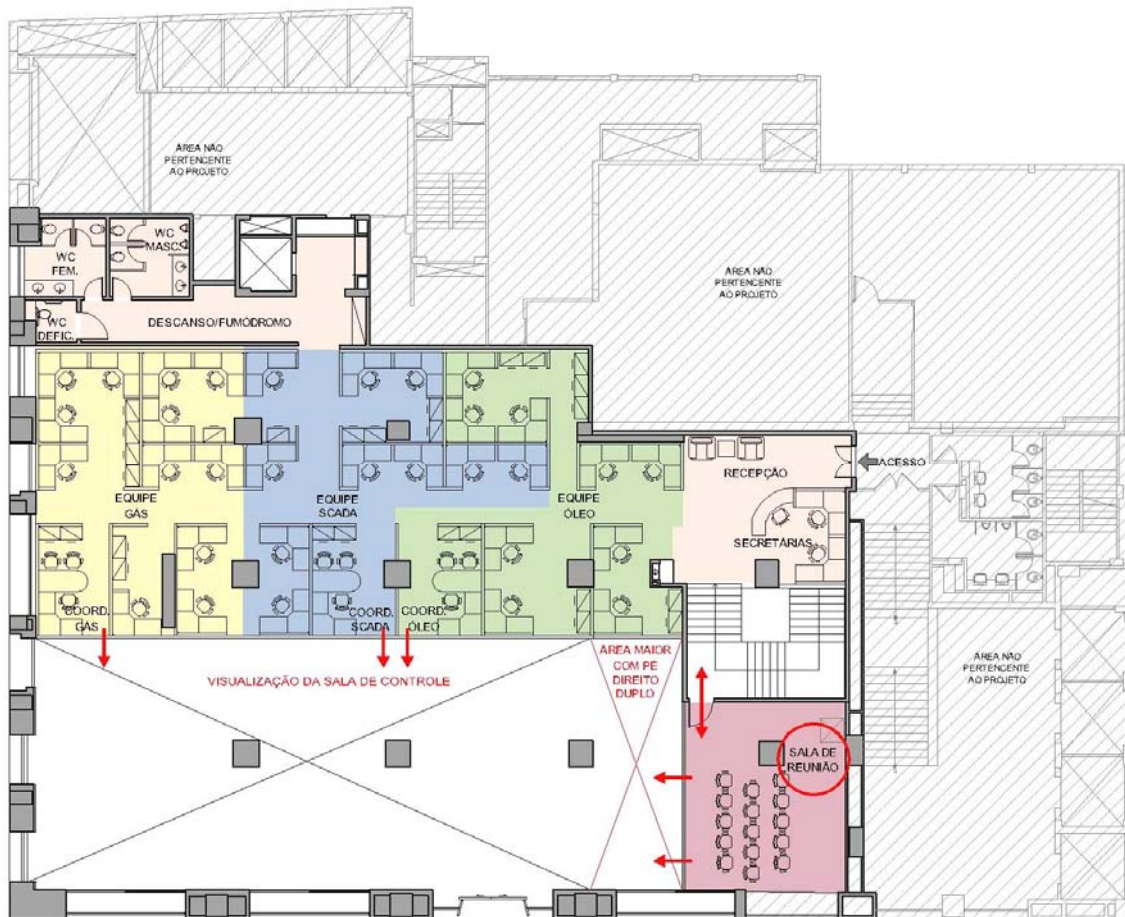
Planta baixa mezanino: opção 2 para o layout (dois de junho)
